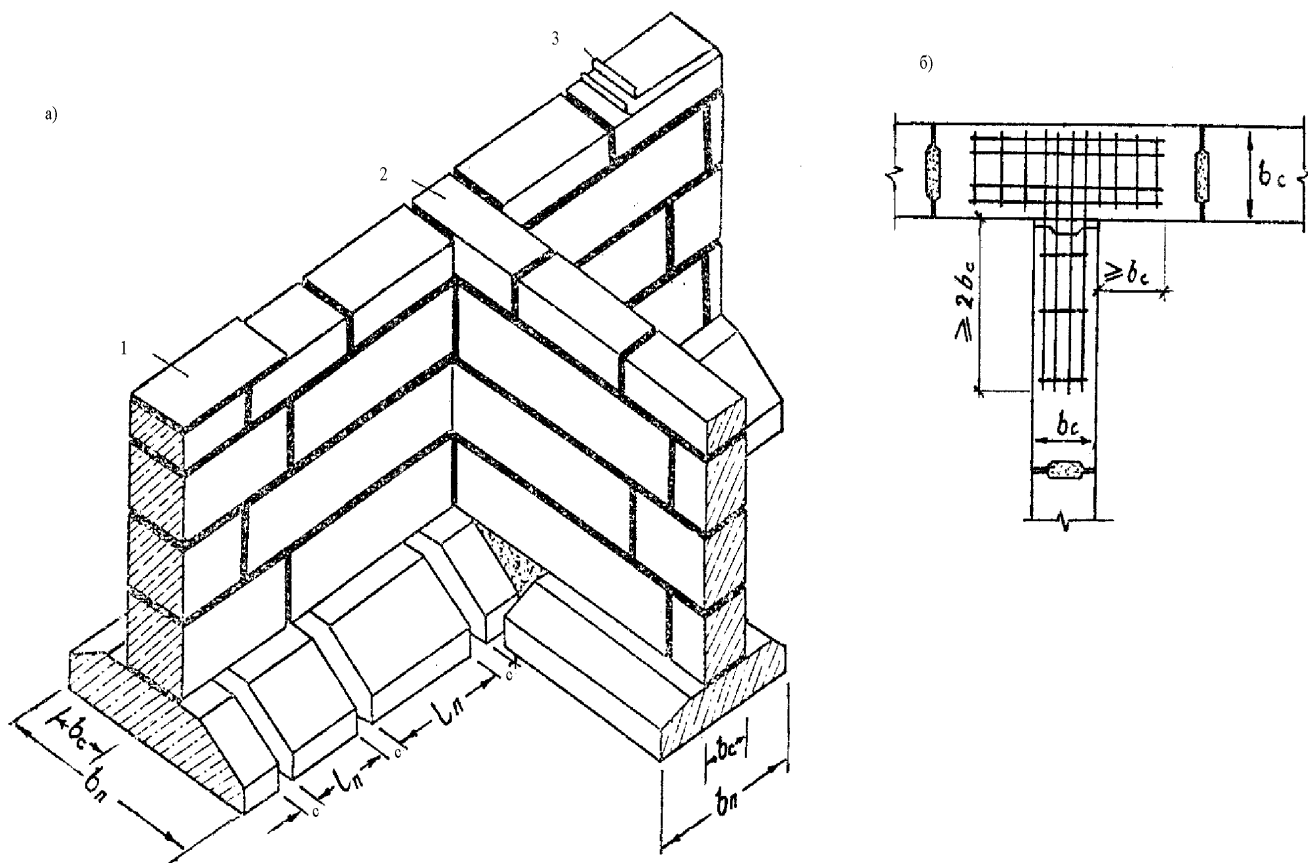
а) перев'язка блоків поздовжніх і поперечних стін: 1 – вирівнена поверхня стін підвалу; 2 – перев'язка блоків; 3 – гідроізоляція; б) підсилення стін арматурними сітками при їх з'єднанні
